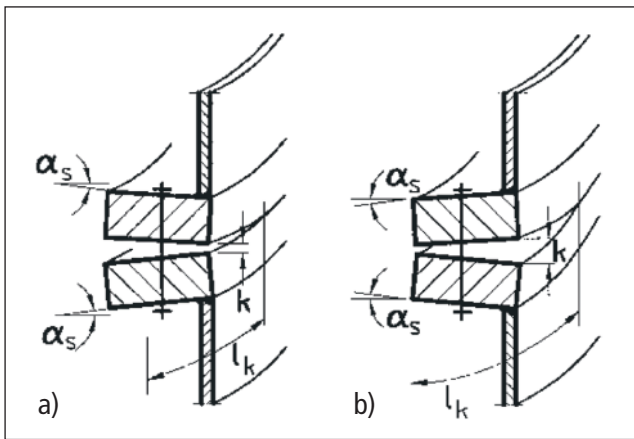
Ringflanschverbindungen in stählernen Türmen (aus DIBt-Richtlinie [13])
